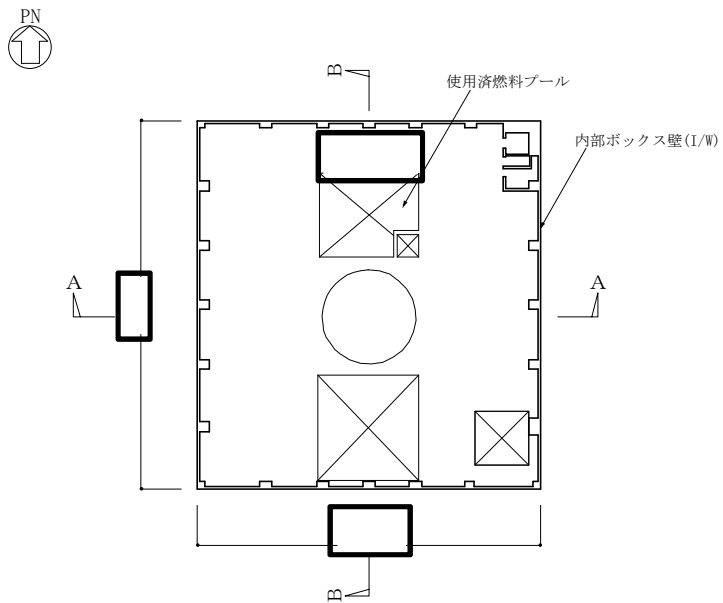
(2/2)  の概略平面図 (EL. 46.5 m)
